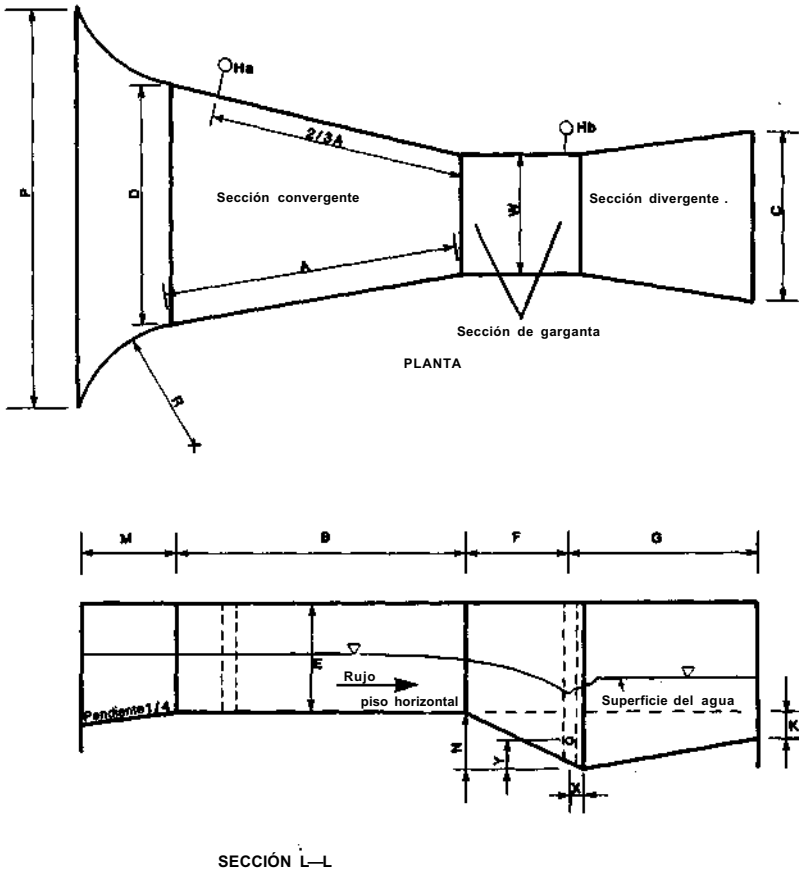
planta, perfil y dimensiones del medidor Parshall.
